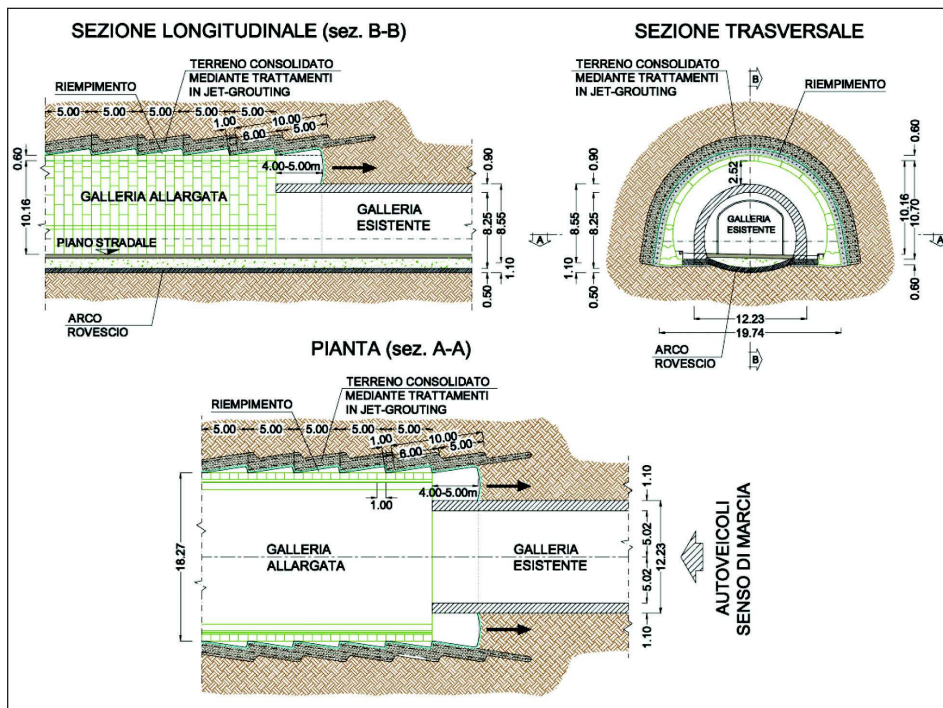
Sezione tipo con jet-grouting (progetto Rocksoil S.p.A.).
